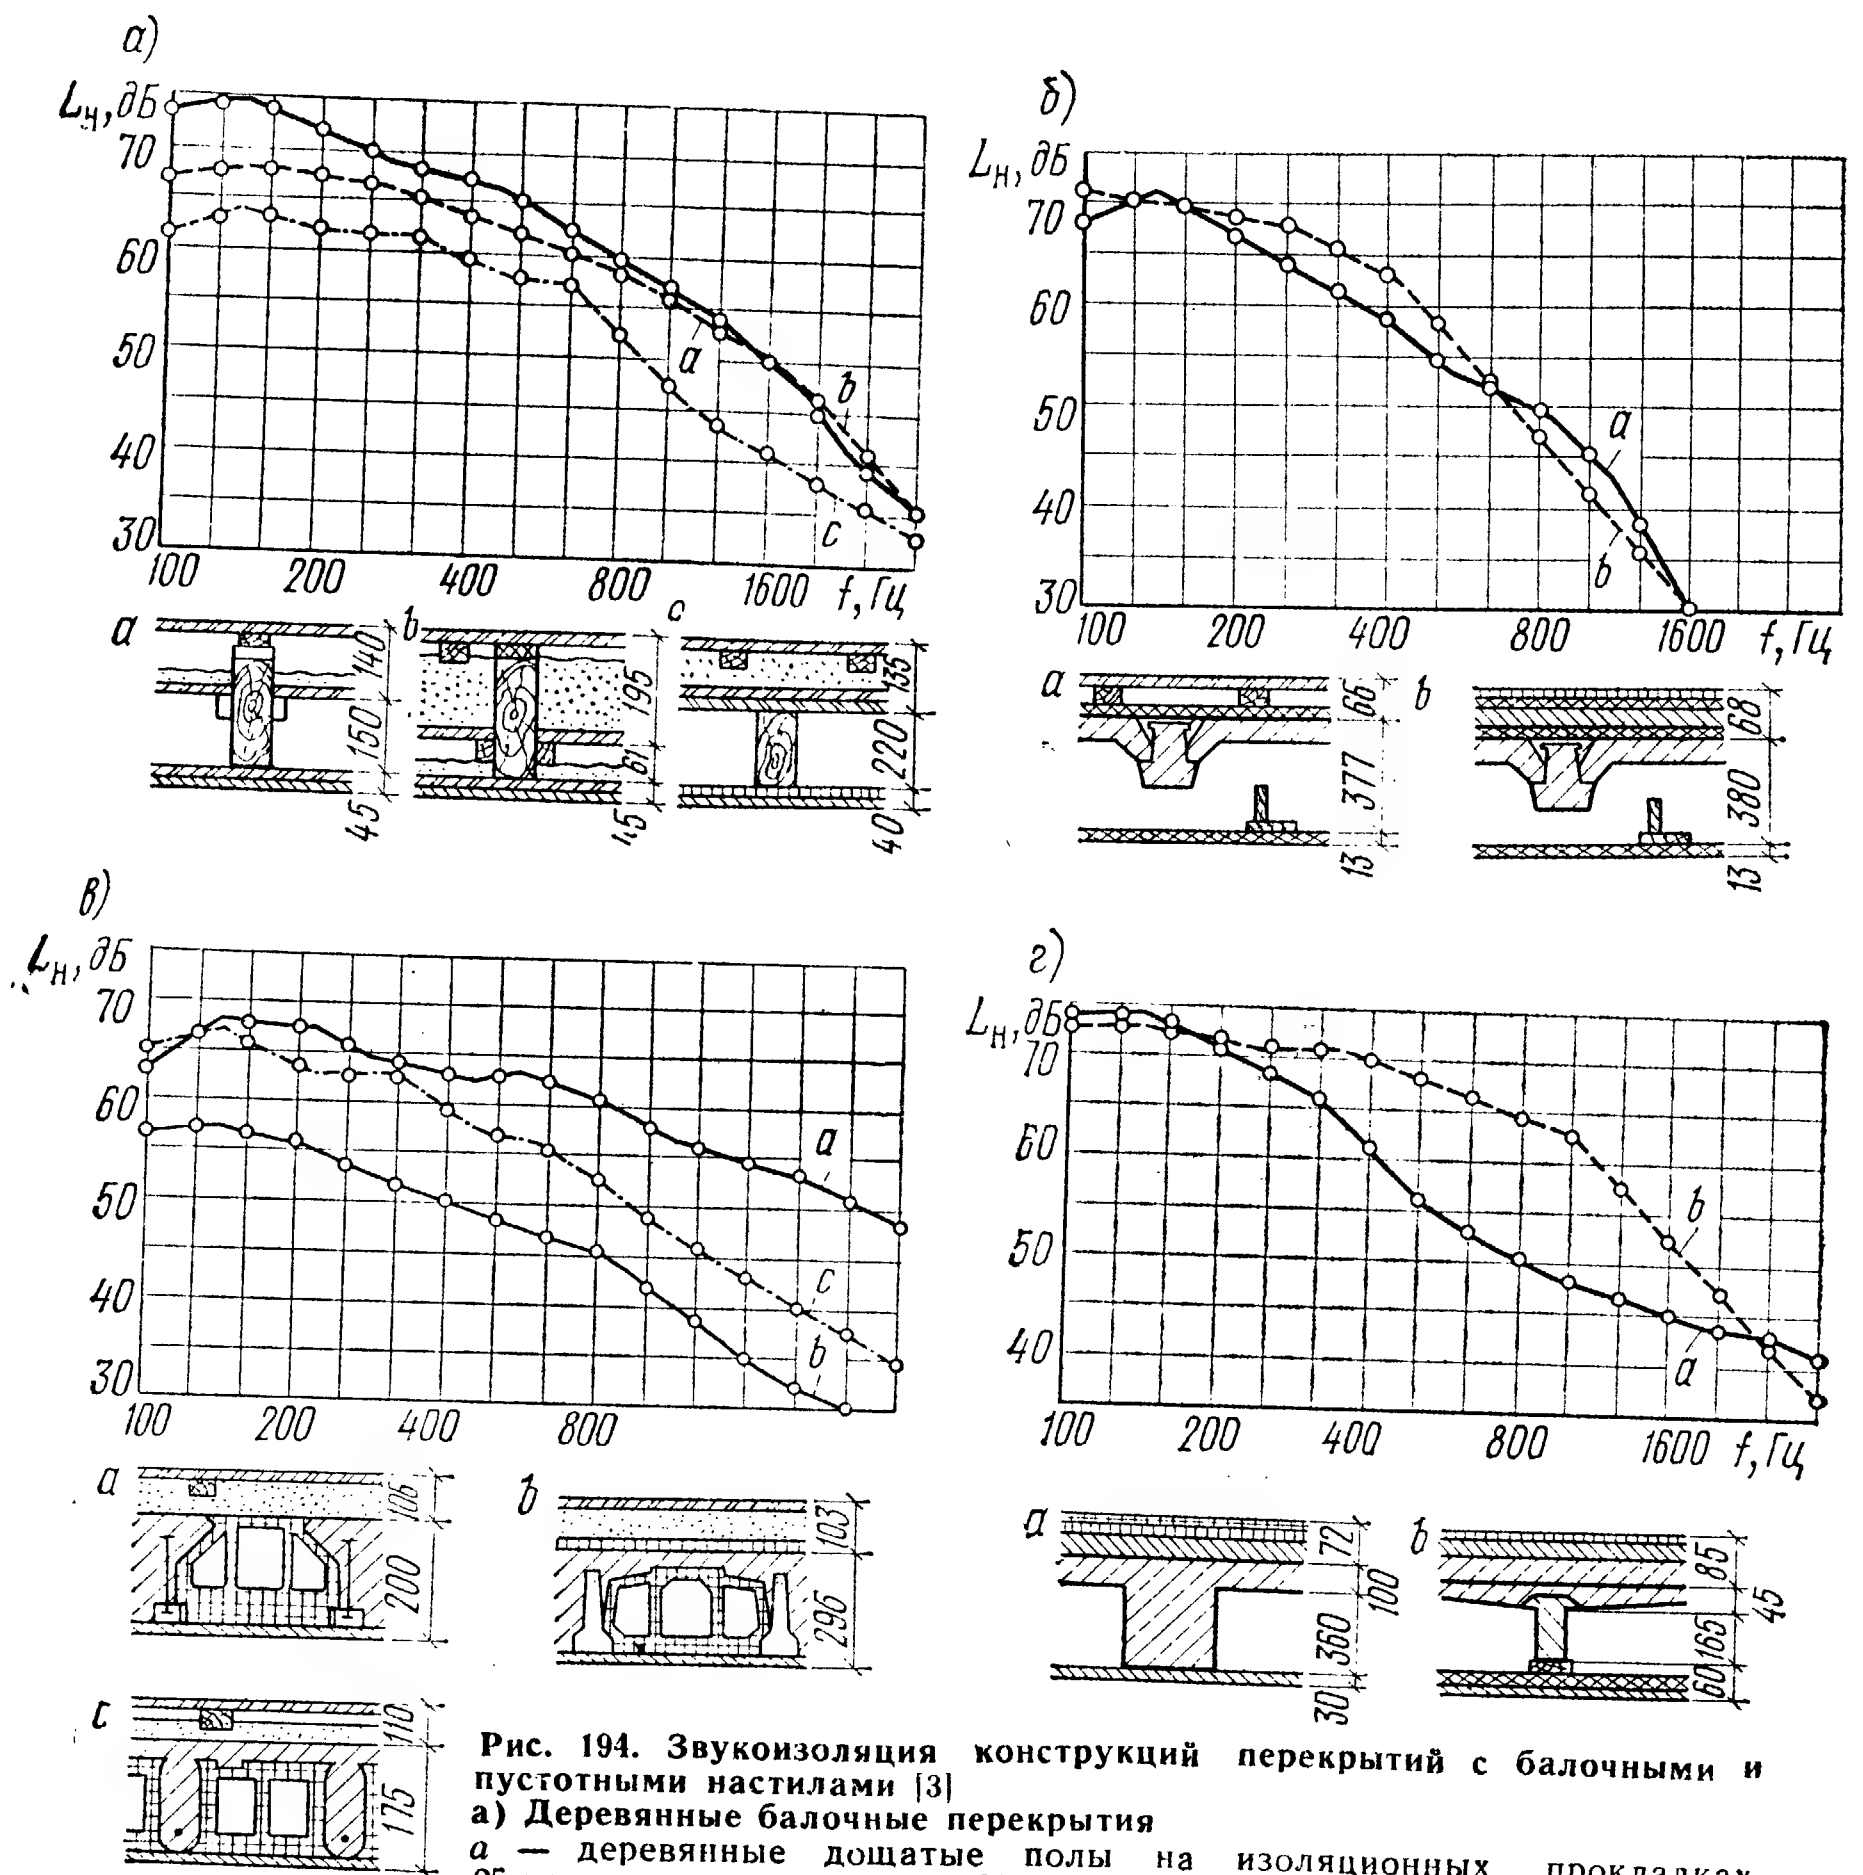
Звукоизоляция конструкций перекрытий с балочными и пустотными настилами [3]
